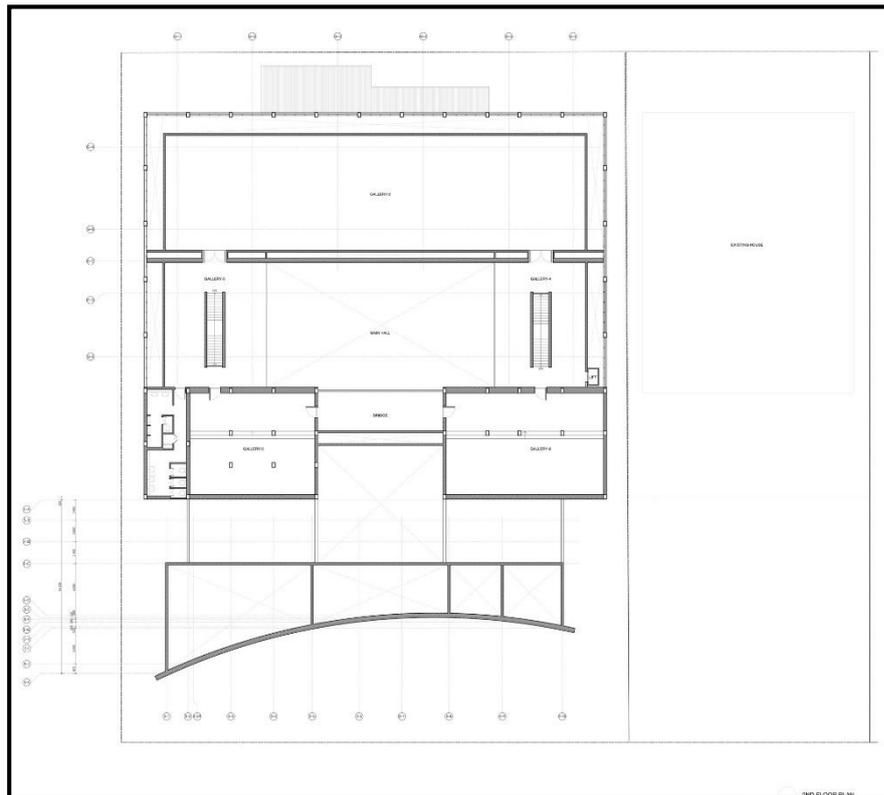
Layout eksisting lantai 1 MAIIAM.
